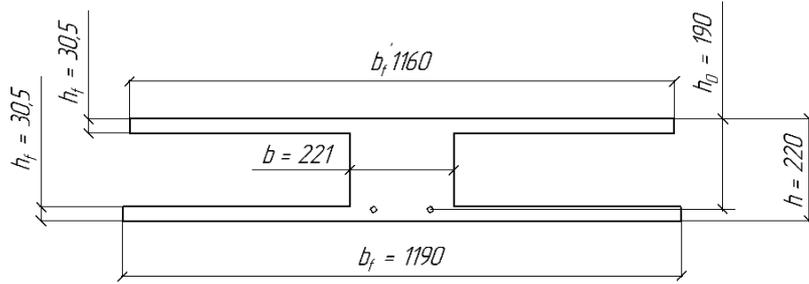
Сечение многопустотной плиты, расчетное
